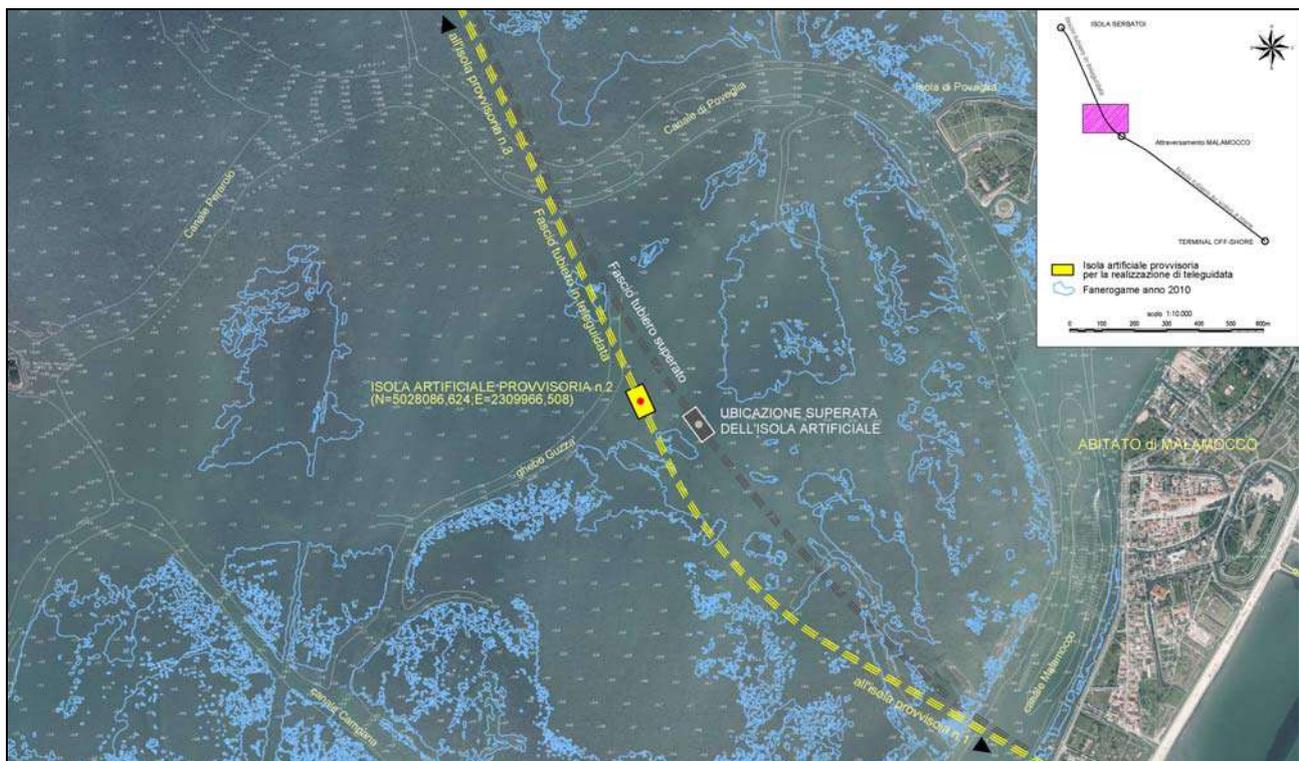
Planimetria di dettaglio con la nuova ubicazione dell'isola artificiale provvisoria n.2.
